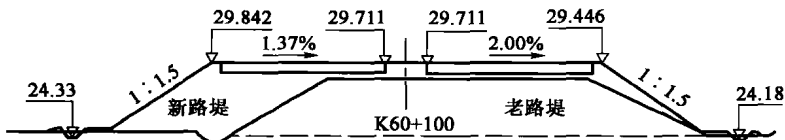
威乳路 K60+100 横断面图(尺寸单位:m,高程单位:m)
